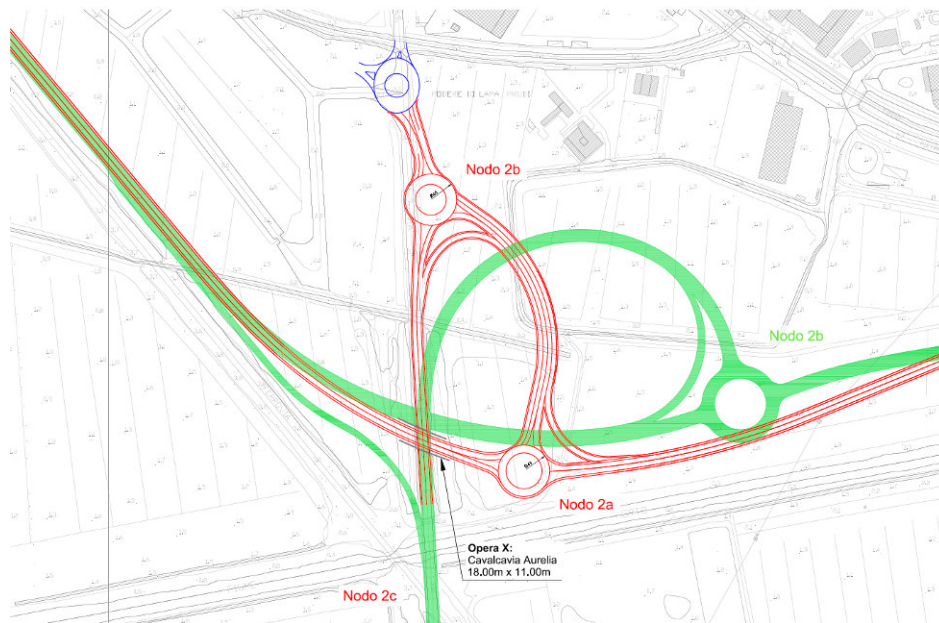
Planimetria di dettaglio Nodi 2/a, 2/b e 2/c
